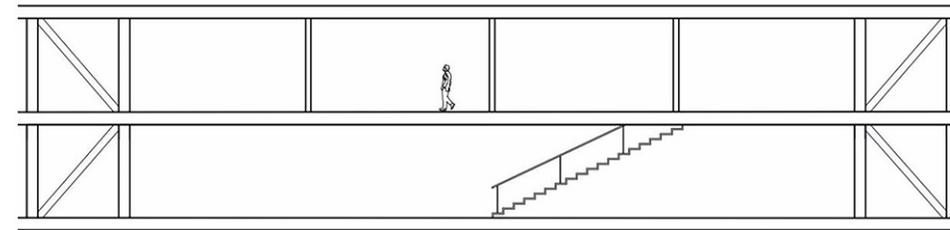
Picture Window House - Elevación posterior. Elaboración: Shigeru Ban Architects
